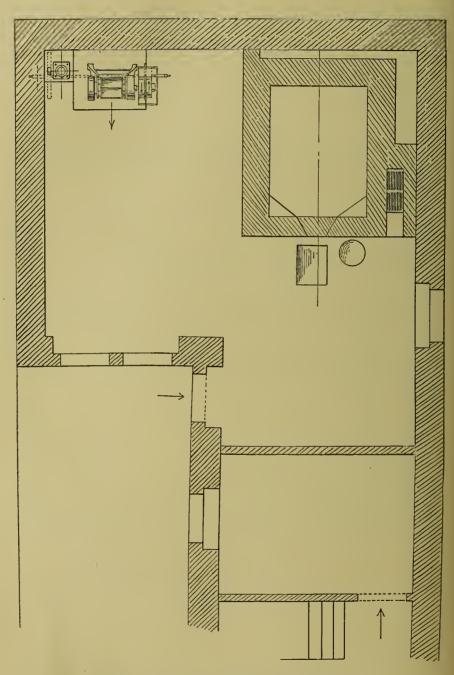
Grundriß einer Baderei mit Maschinenbetrieb.
